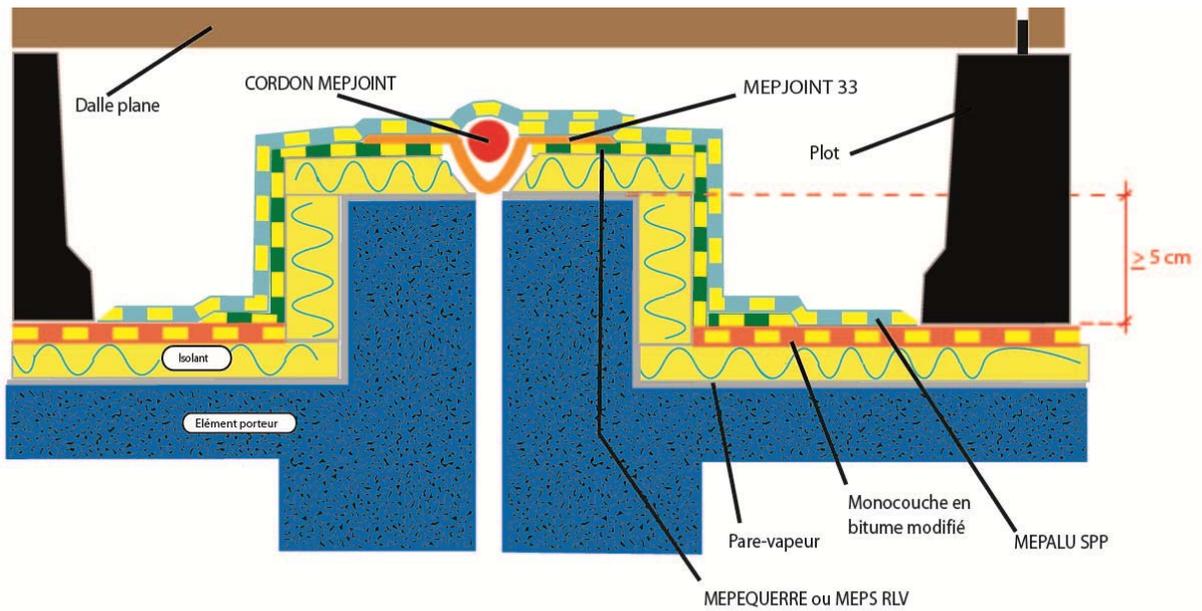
ter : Exemple de joint plat surélevé, dalles sur plots (cas du monocouche)
